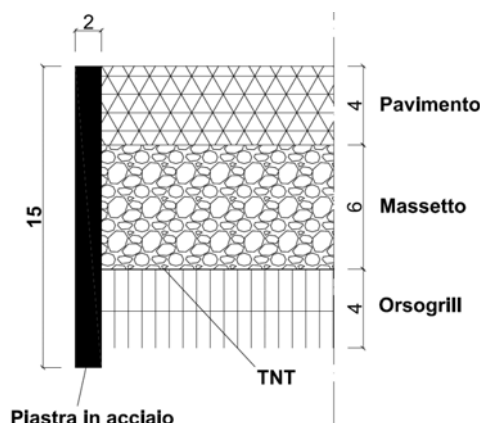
C – Sezione estratta dal report delle indagini strutturali solaio a quota -0,50 m
